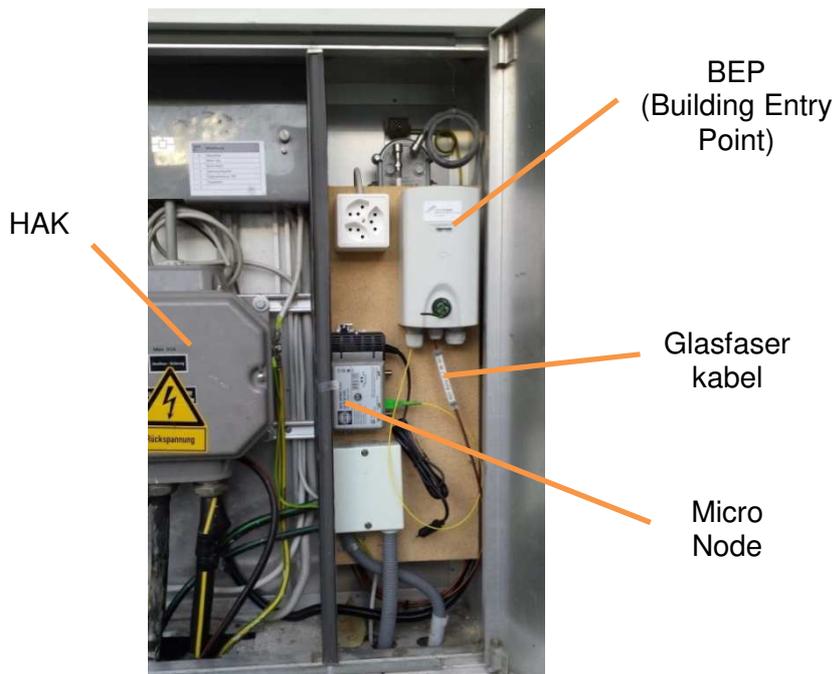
FTTB bestehendes Gebäude mit Aussenzählerkasten
